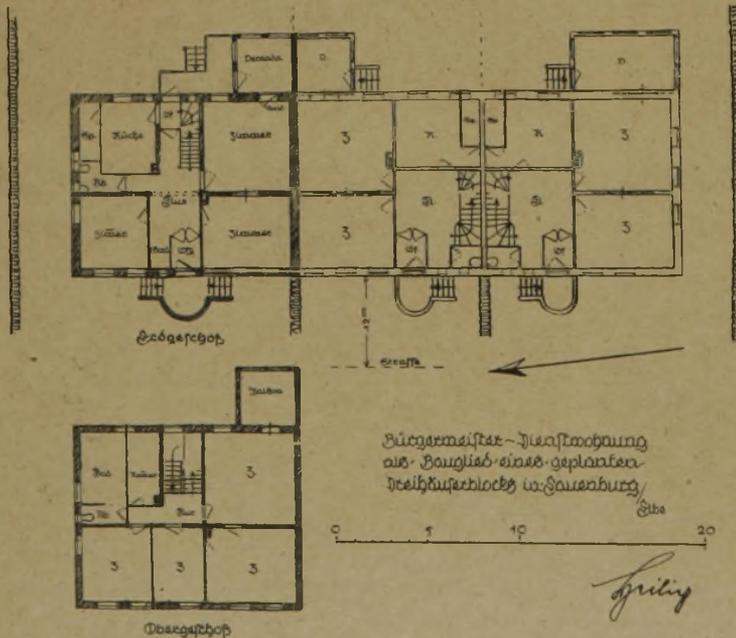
Grundrisse des Bürgermeisterhauses in Lauenburg.
